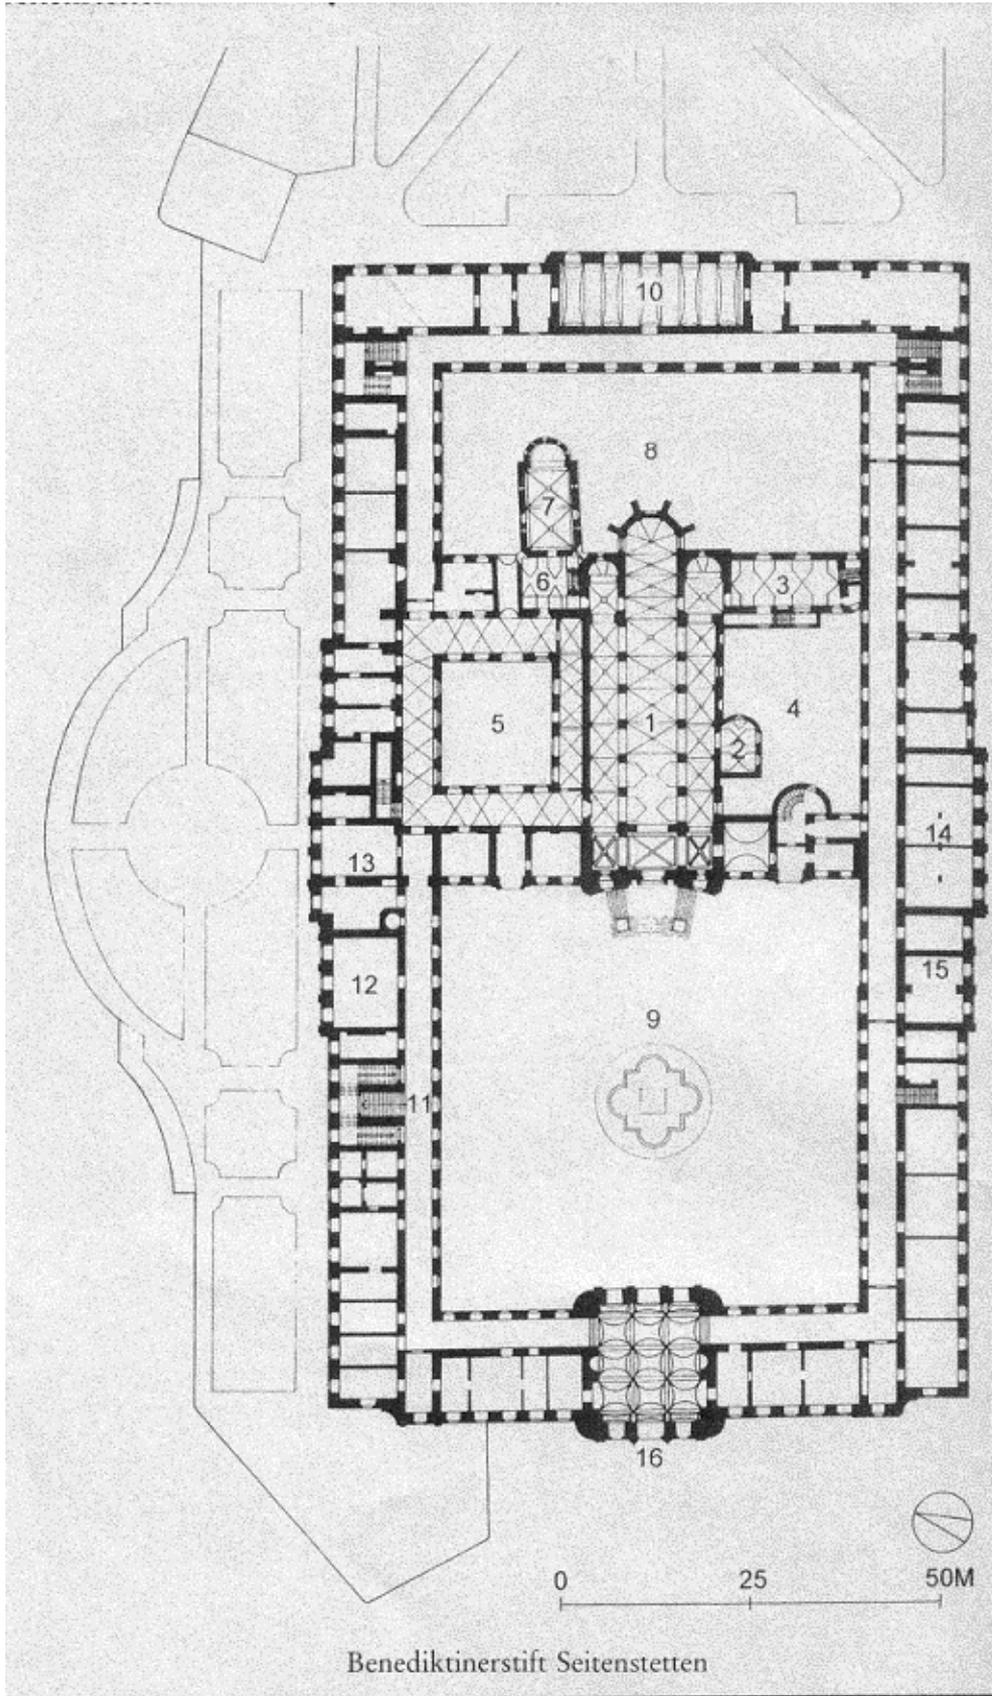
Seitenstetten, Benediktinerstift Seitenstetten, Grundriss
